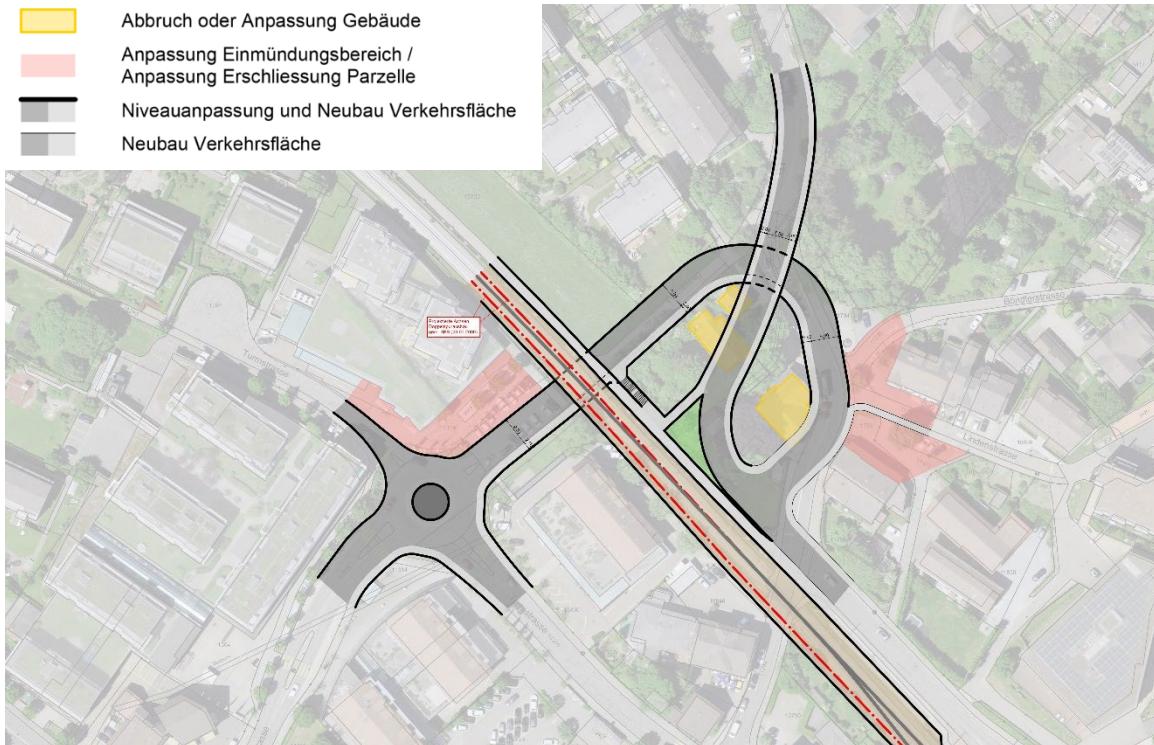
Schemaplan Unterführung Tunnelstrasse Variante "T40"
